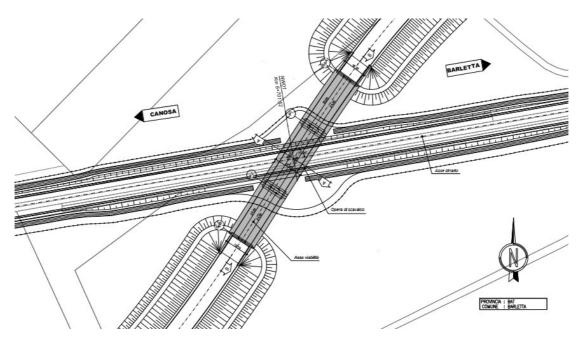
Cavalcaferrovia NW01 – Planimetria
